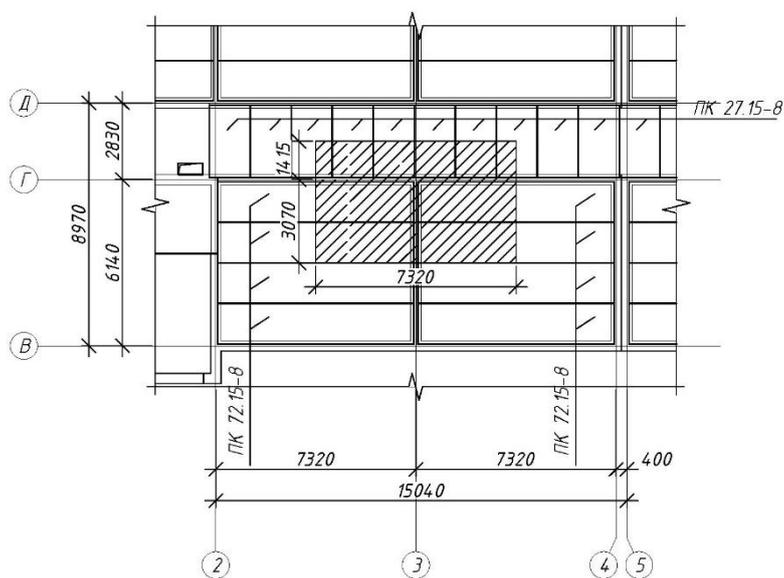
Сбор нагрузок на грузовую площадь от межэтажного перекрытия
